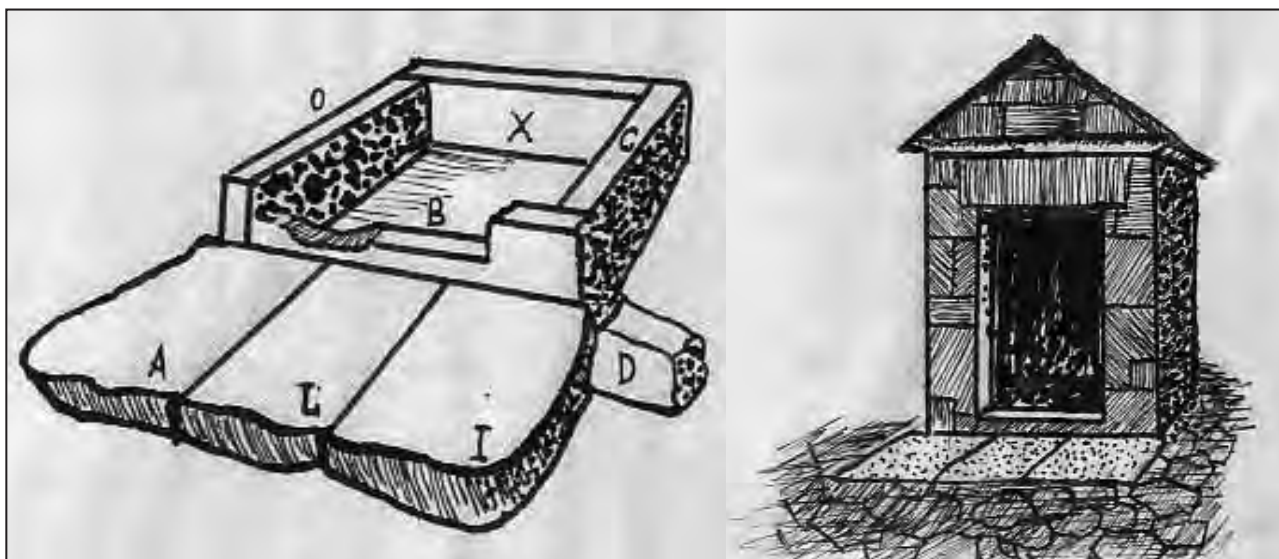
Castelló. Planta y alzado de los restos romanos junto a la *Senda de la Palla*, según J. B. Porcar.
